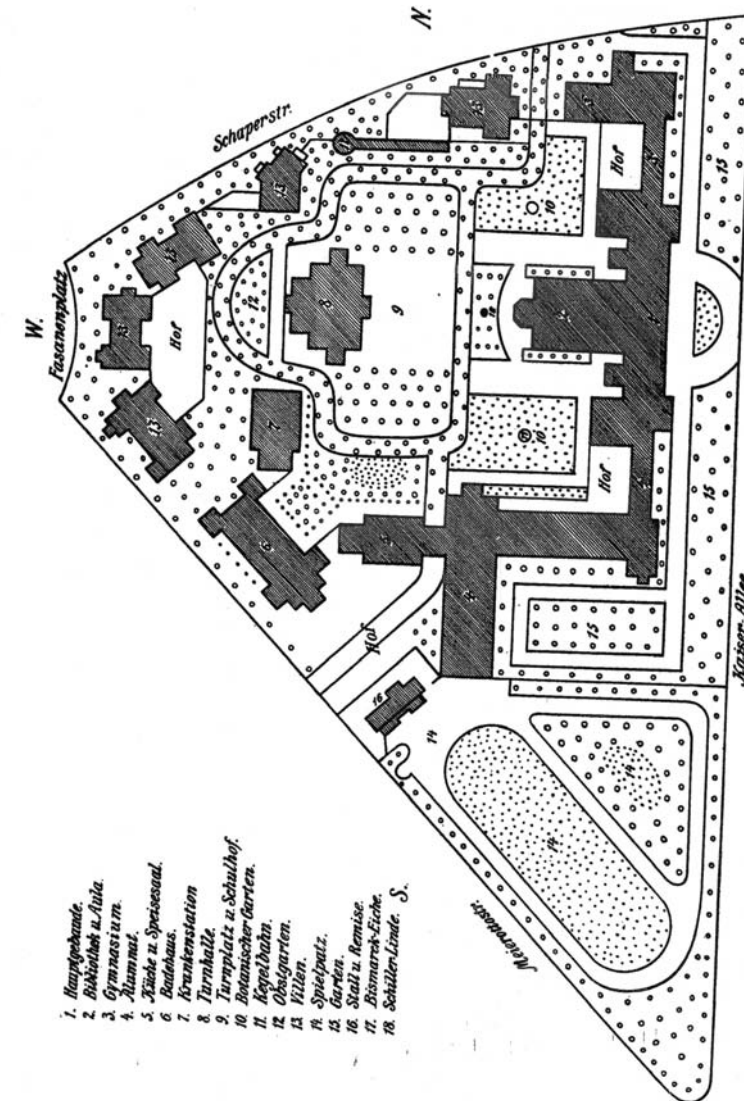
Grundriss der Gesamtanlage des Joachimsthalschen Gymnasiums in Wilmsdorf (aus JOOST 1982).
